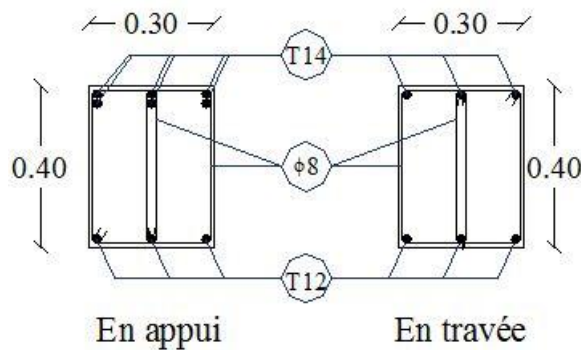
Ferrailage des poutres principaux(bloc A/B/C/D)
